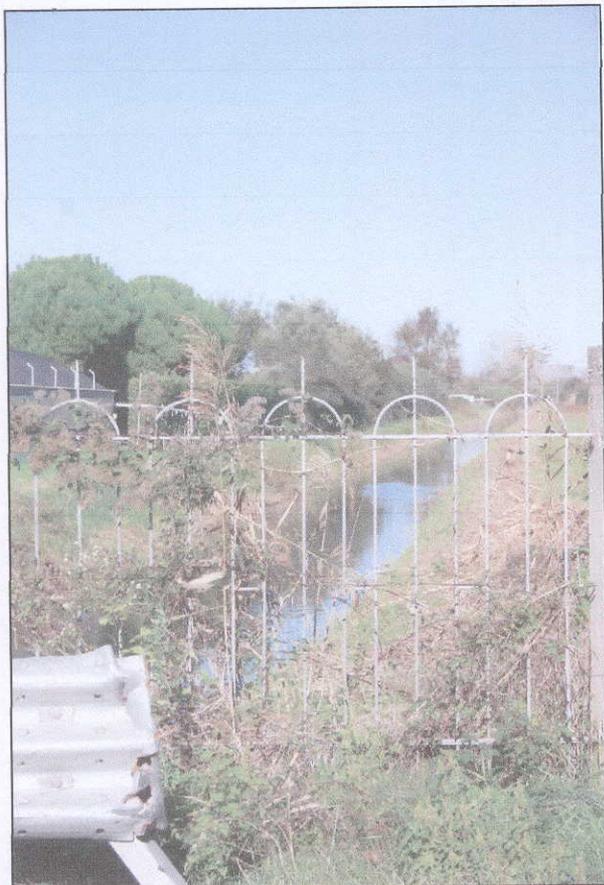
Vista dell'alveo del Fosso Lamone in direzione Marina di Pisa.
